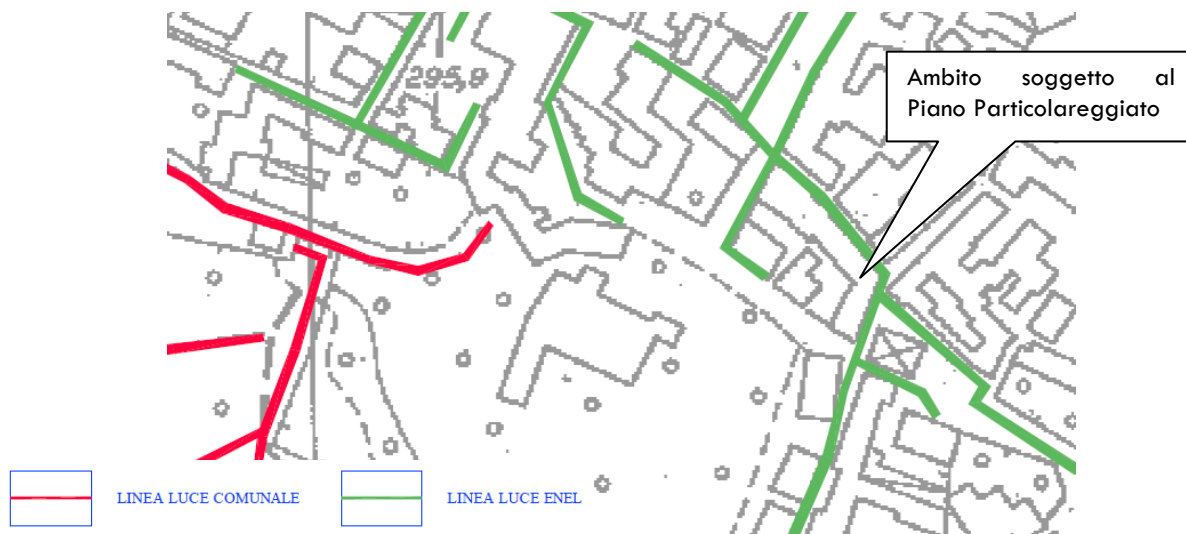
Estratto PRG vigente, Tavola 2/A "Rete illuminazione"
